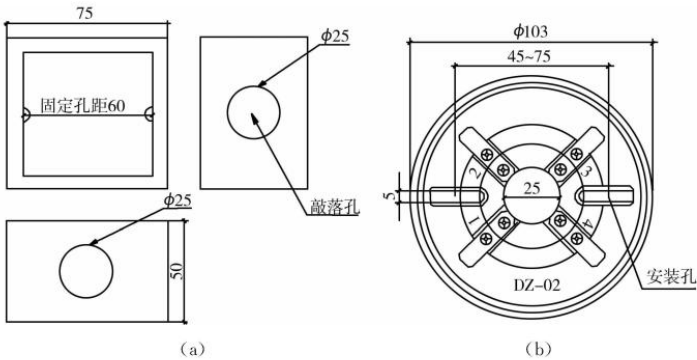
预埋盒和通用底座的外形示意图 (单位:mm)
